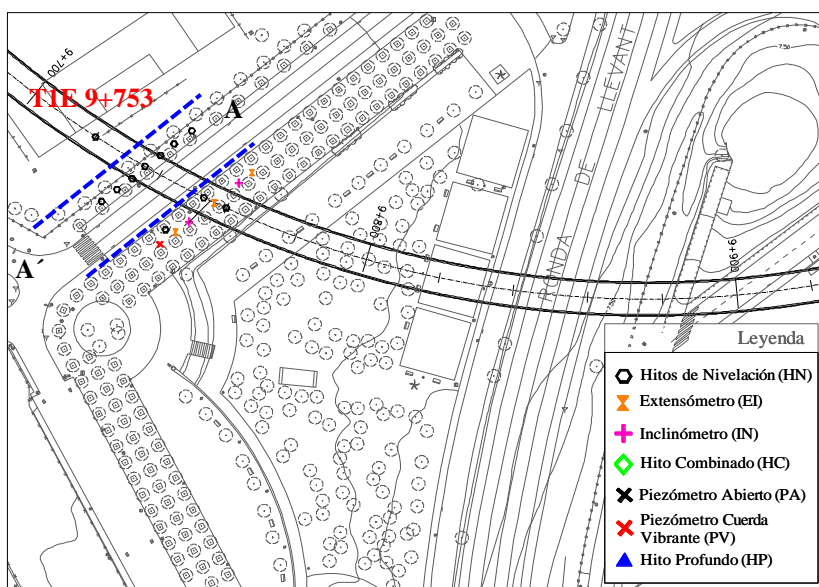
48. Situación en planta del túnel y la sección de control TIE PK 9+753
